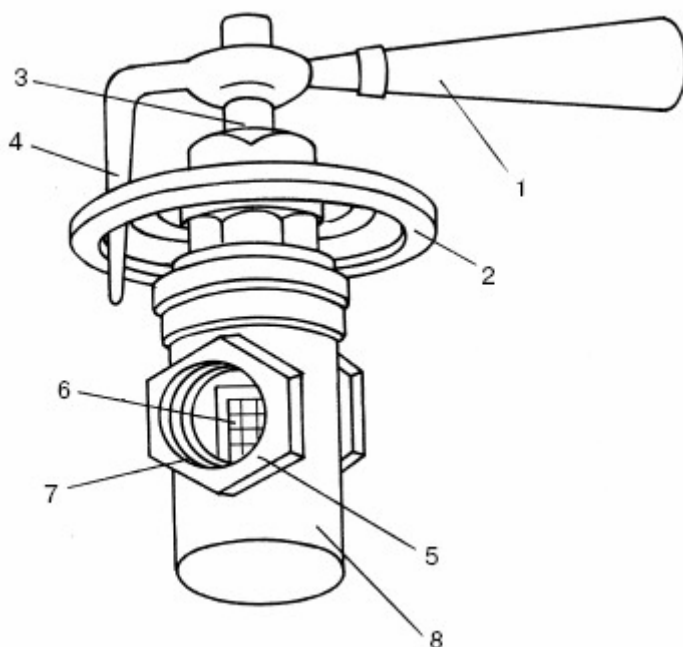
Кран двойной регулировки: 1 – рукоятка; 2 – розетка; 3 – шпindelь; 4 – упорный палец; 5 – проход корпуса; 6 – боковое окошко; 7 – полый бронзовый стакан; 8 – корпус
